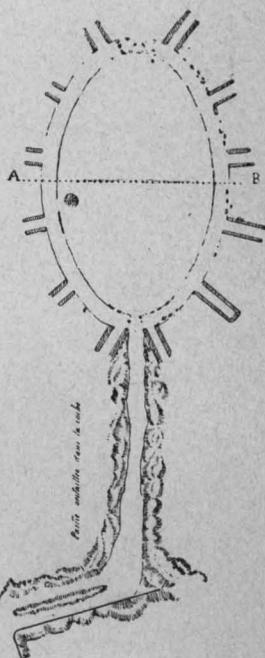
FESGUIA DE L'OUED ROUGGA. Plan et Coupe.
